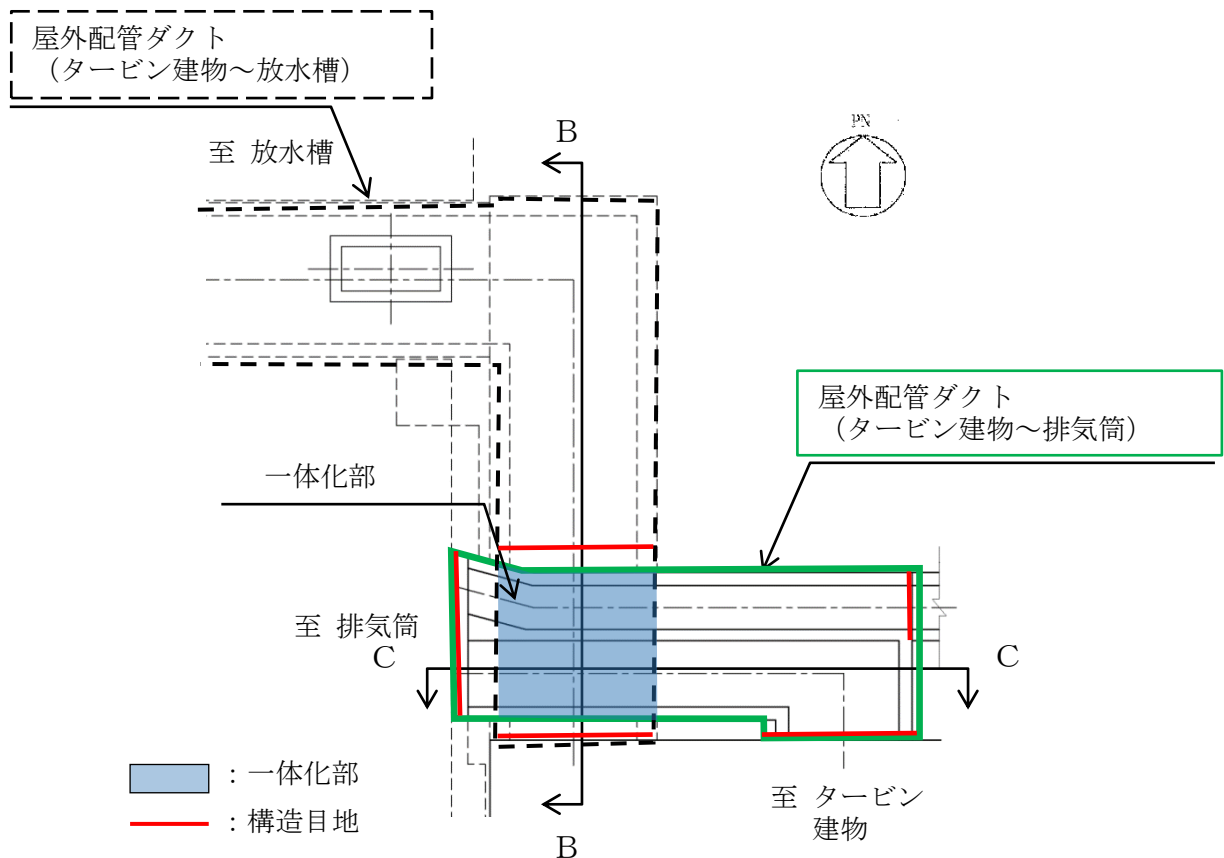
屋外配管ダクト（タービン建物～排気筒） 平面図
